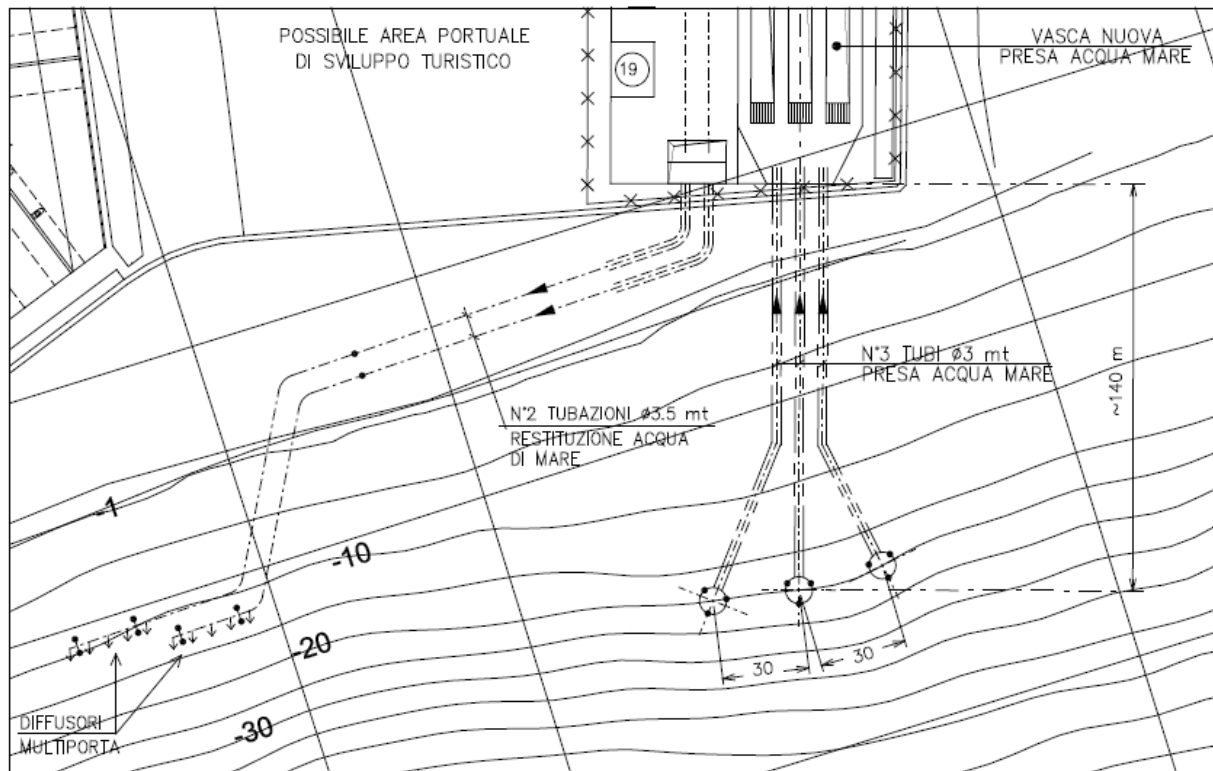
Layout presa e scarico acqua mare (Estratto dalla Tavole di Progetto n. BD0362A-0-01-001)
